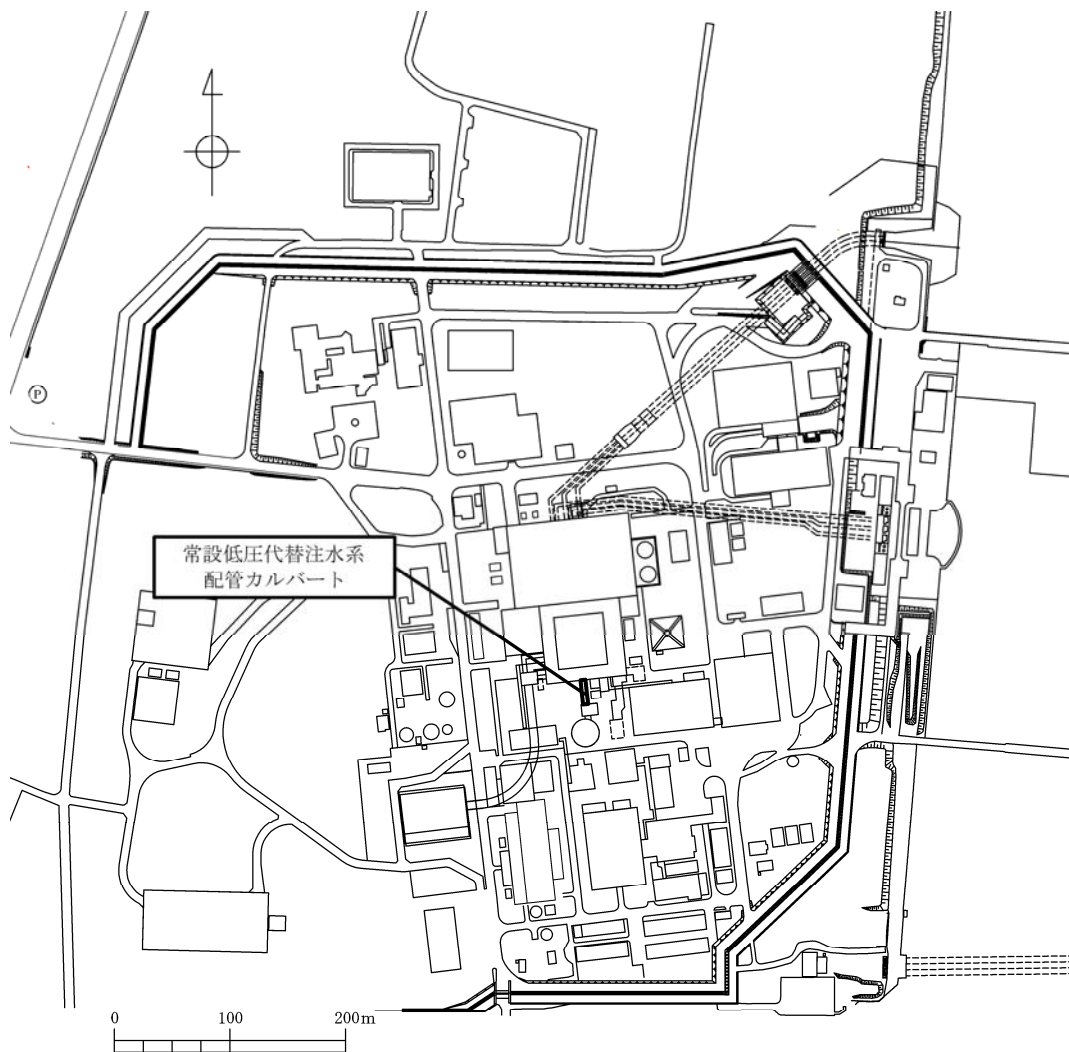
(1) 常設代替注水配管カルバート 平面位置図 (全体平面図)
